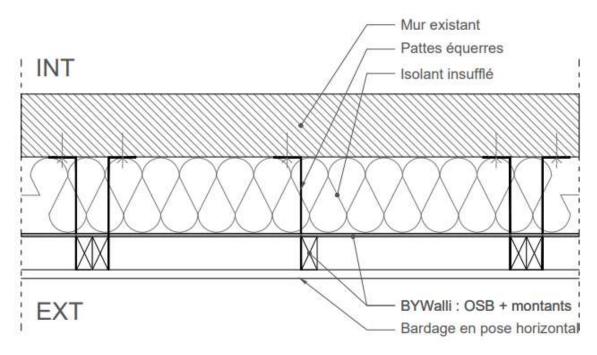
Vue en plan du BYWalli avec bardage horizontal
